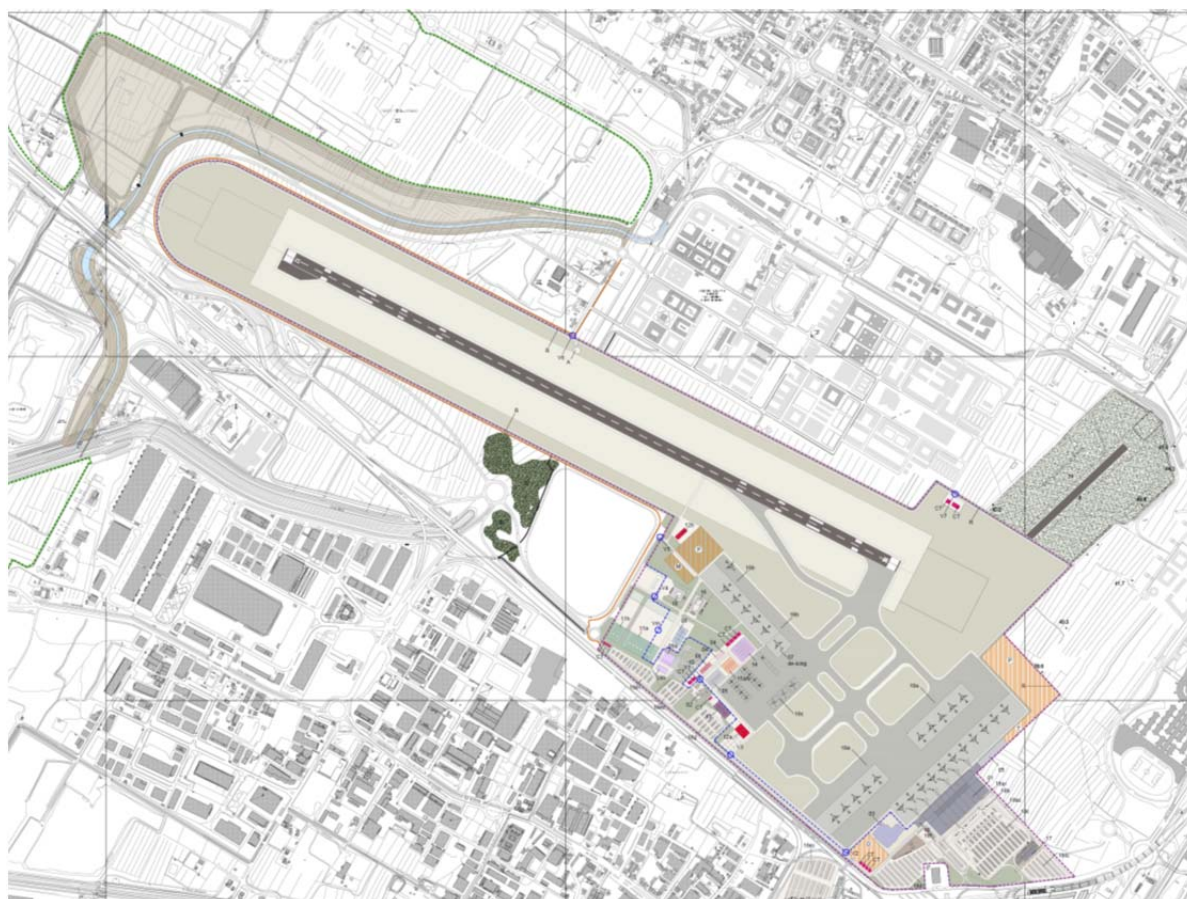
Configurazione planimetrica della nuova pista (Master Plan, scenario 2029)
